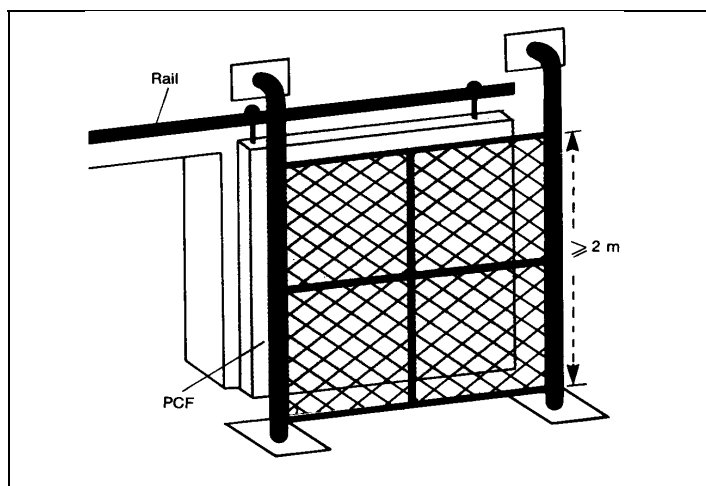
a. : Exemple d'un dispositif de protection d'une porte coupe-feu
